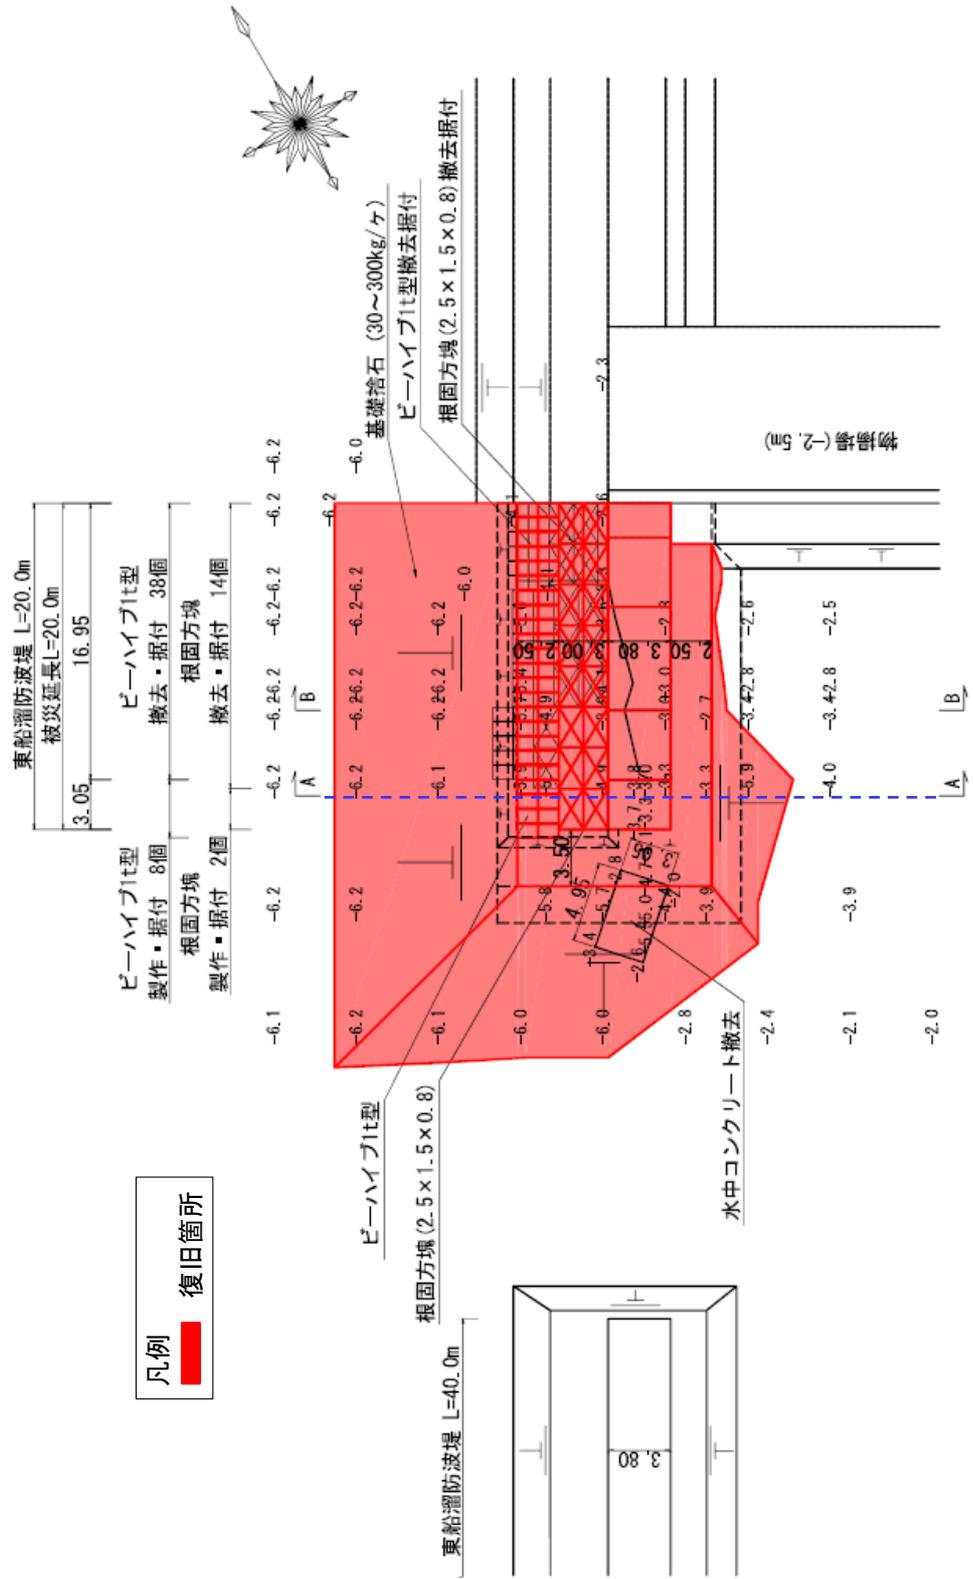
No.4 東船溜防波堤の平面図 (復旧後)
